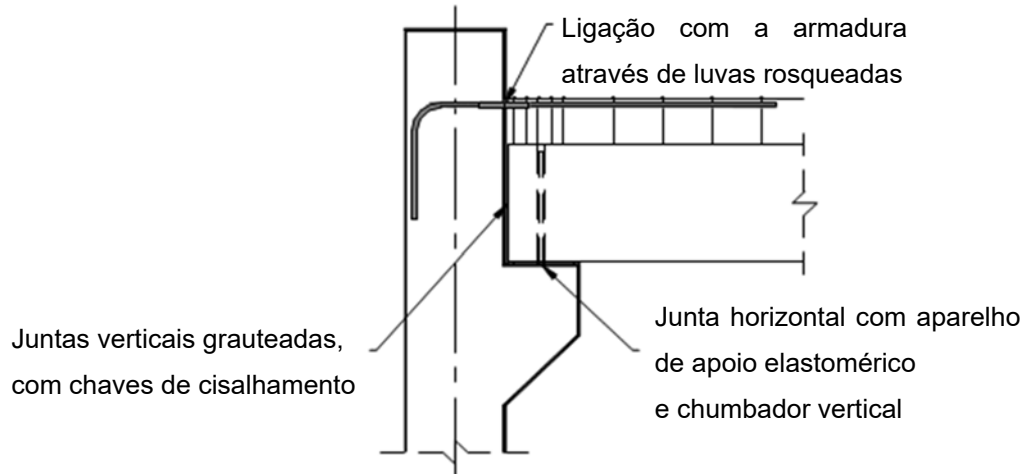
LIGAÇÃO VIGA-PILAR - PILAR INTERNO (TIPOLOGIA 1)
